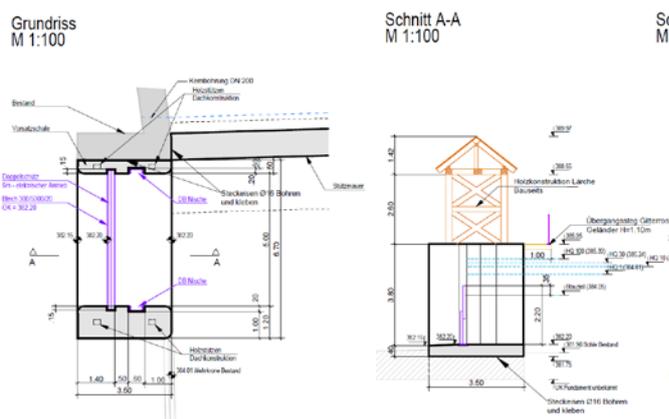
Grundriss und Schnitt Spülbauwerk Streichwehr Traunfall
